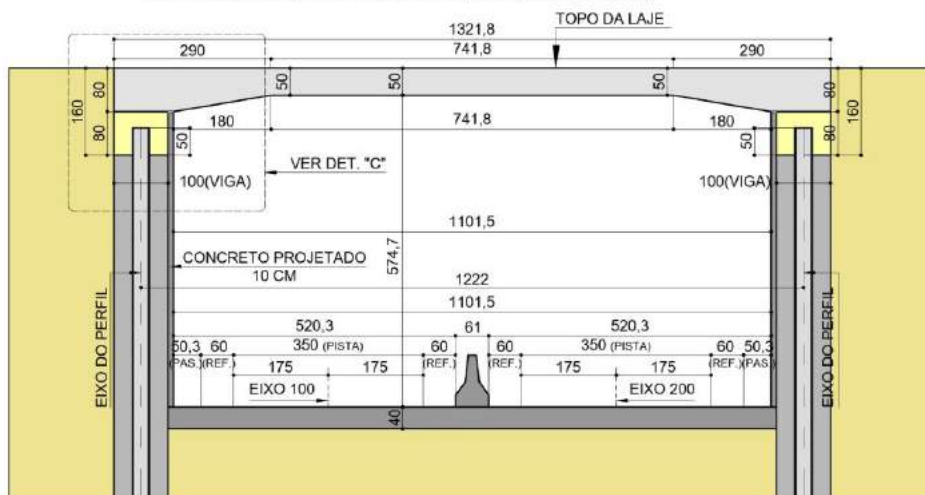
Seções transversais principais - trecho em laje e com pergolado
